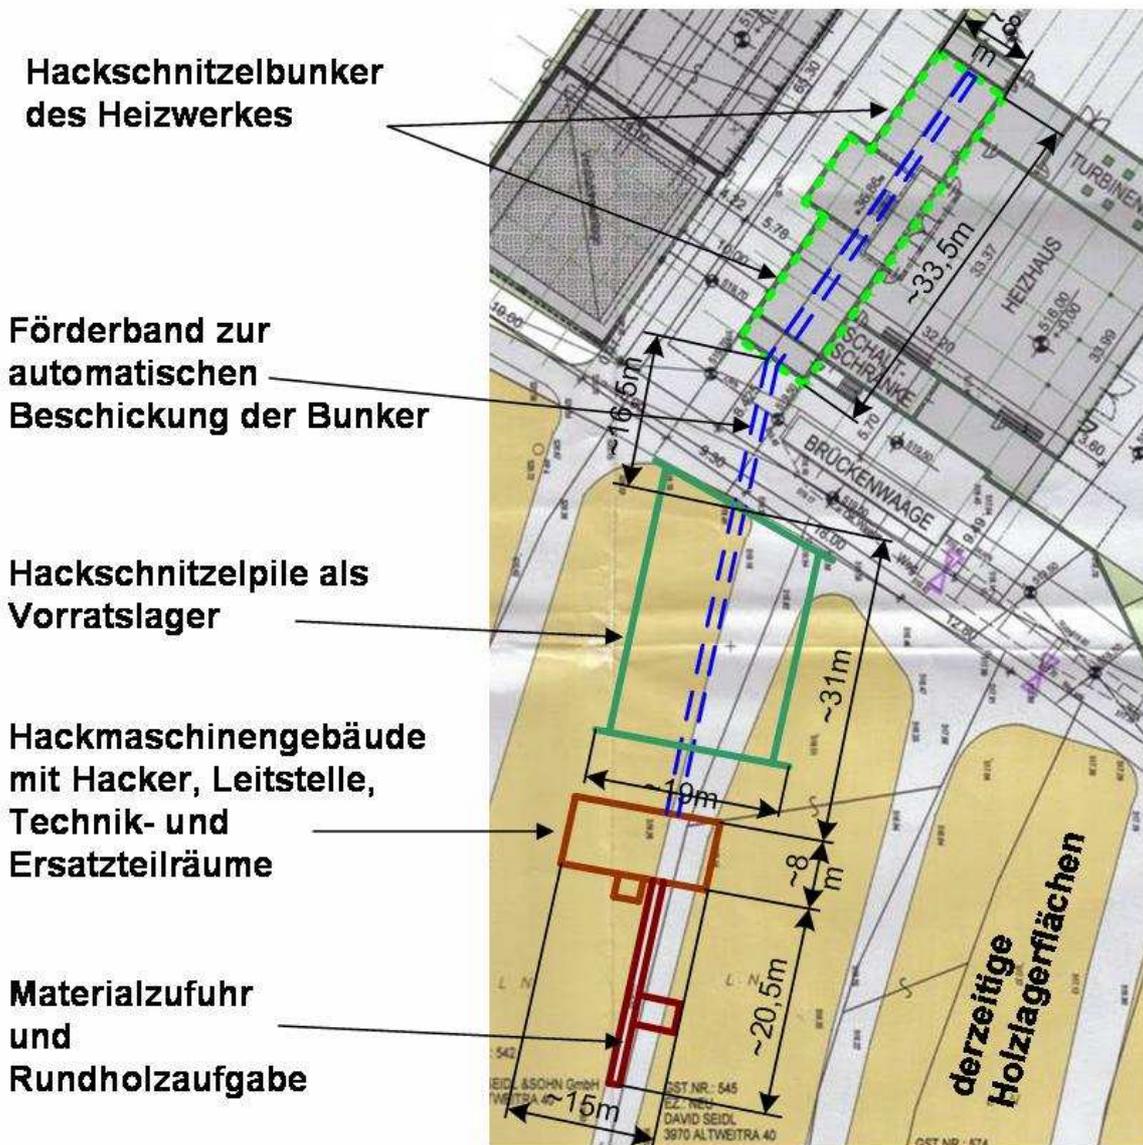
Lageplan stationäre Hackanlage Altweitra
